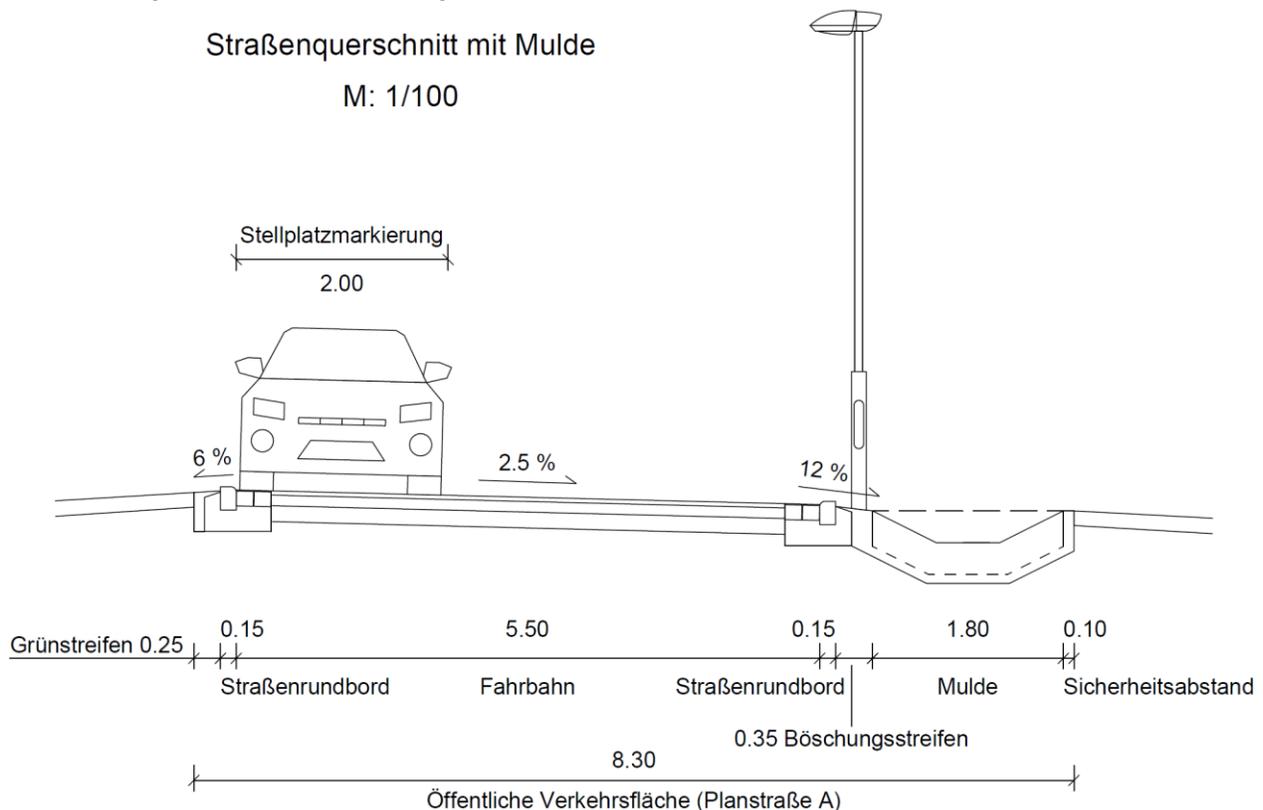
Straßenquerschnitt der Planstraße A mit Versickerungsmulde (Quelle: IPO)
